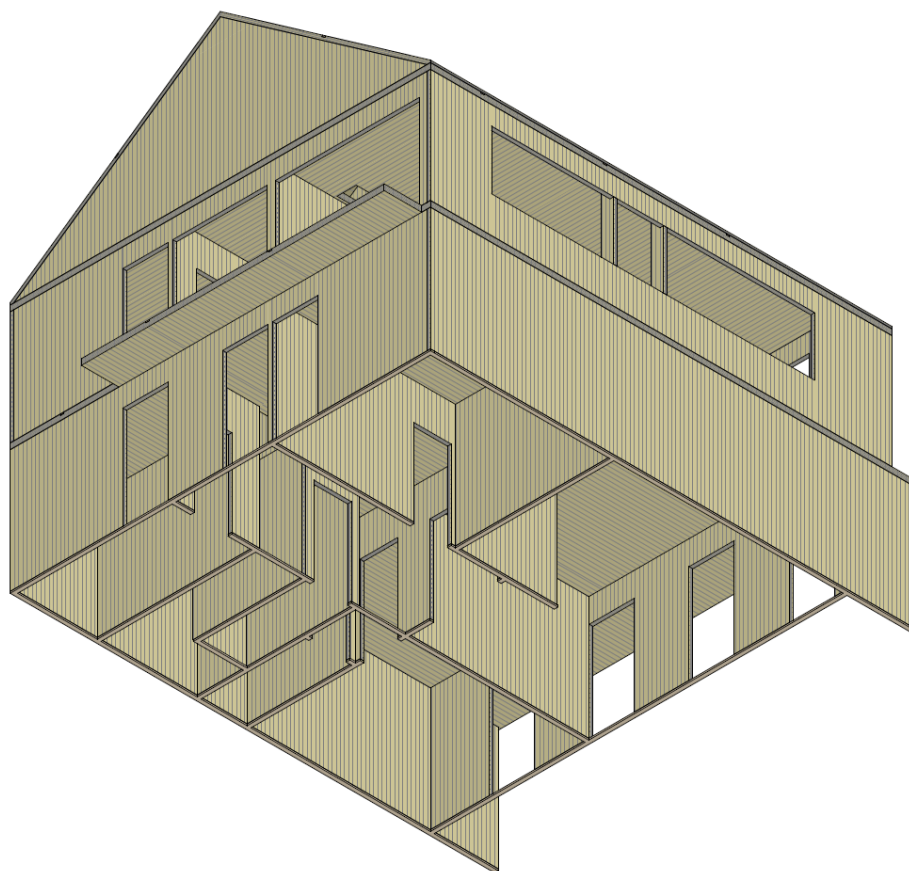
Axonometria noroeste inferior da solução estrutural de painéis pesados de lamelados cruzados colados.
